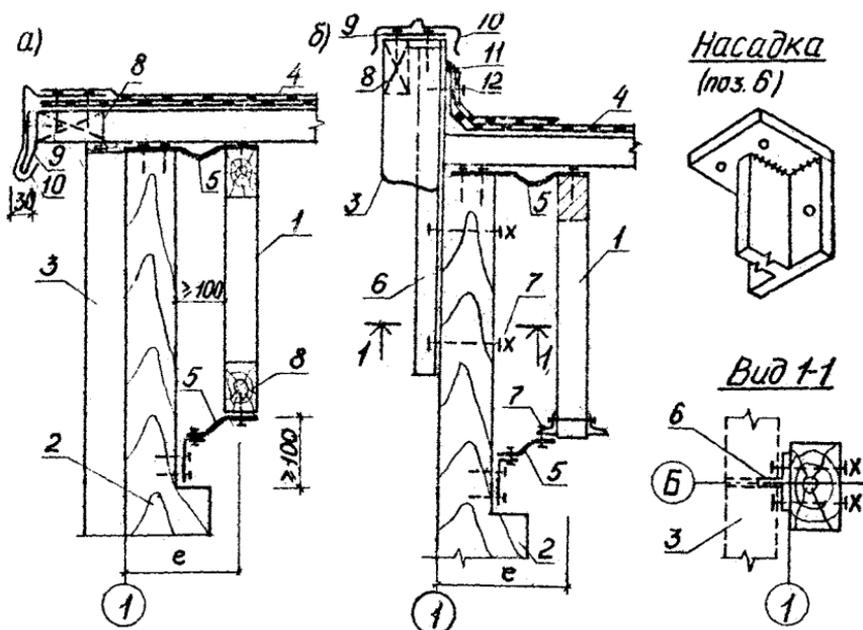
Детали связи факверковых колонн со стропильными конструкциями:
